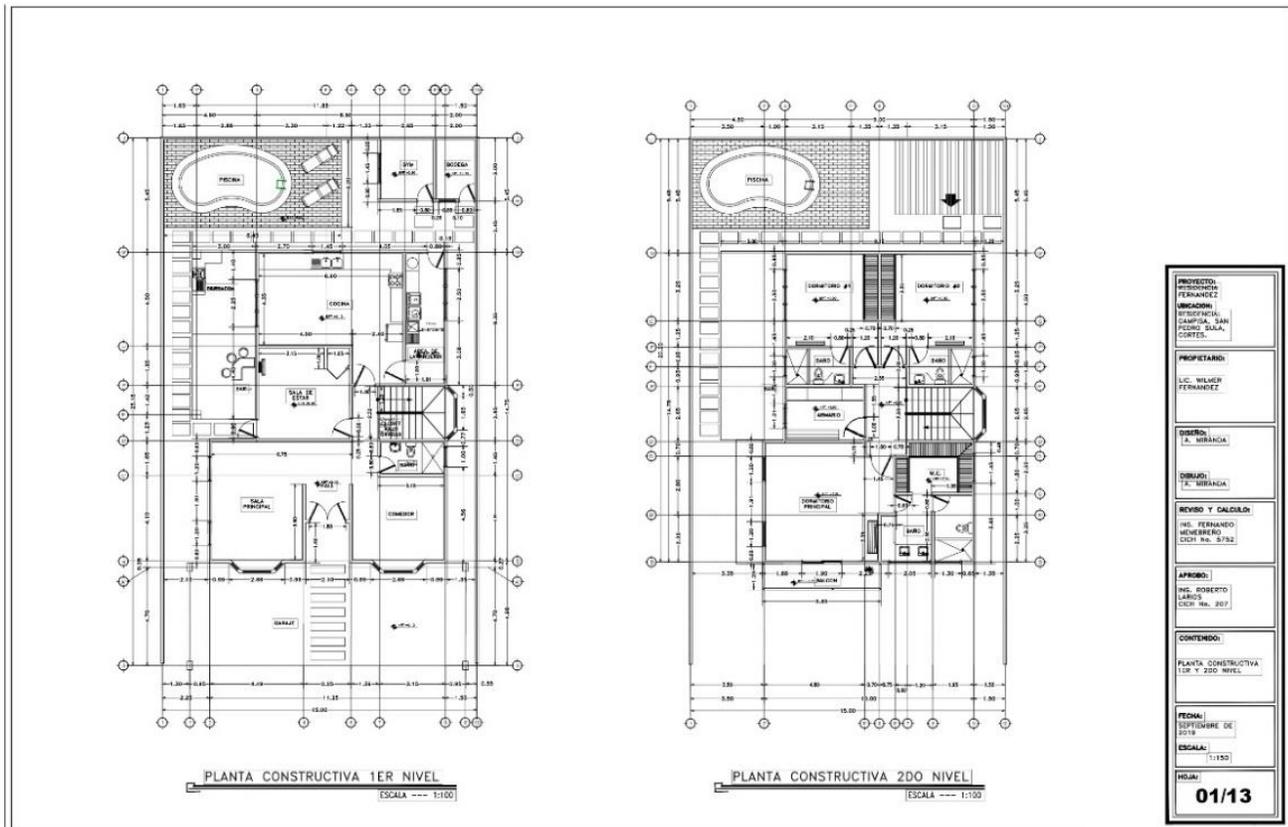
Plantas constructivas, Residencia Wilmer Fernández
